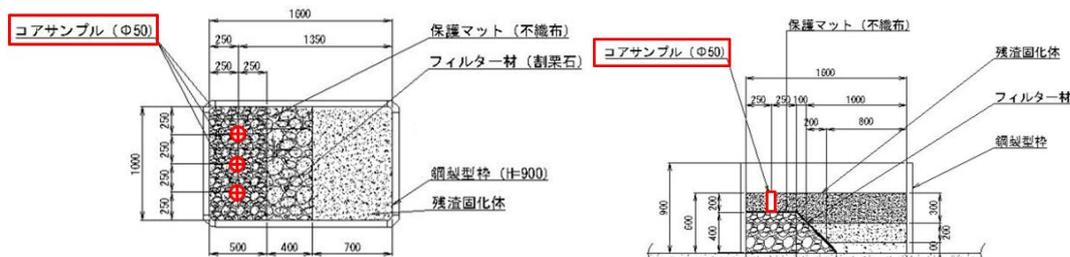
フィルター材との水平接合部でのコア採取位置(左:平面図、右:縦断面図)
